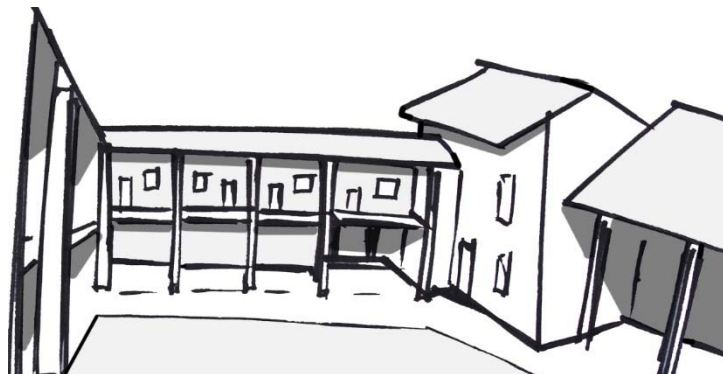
Schizzi di progetto dell'intervento sul corpo B
